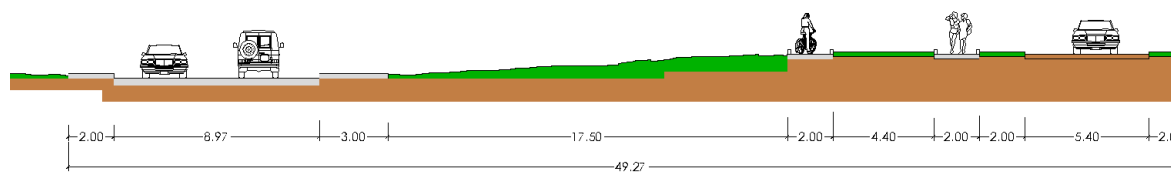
Sección transversal Avenida 24 de Mayo (2)
